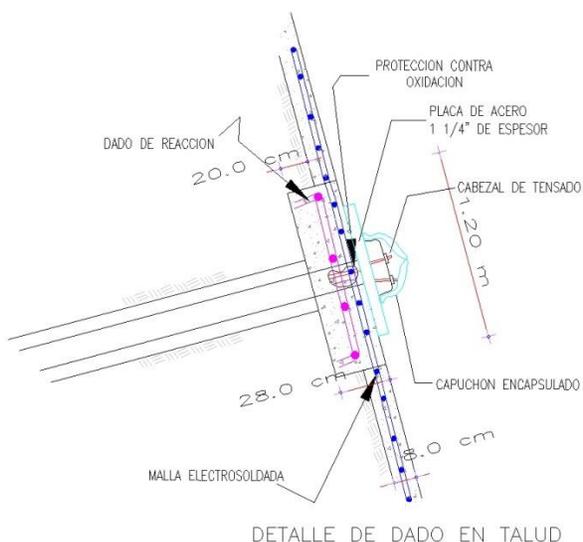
DETALLE DEL MURO DE CONCRETO LANZADO Y DADO DE REACCION
